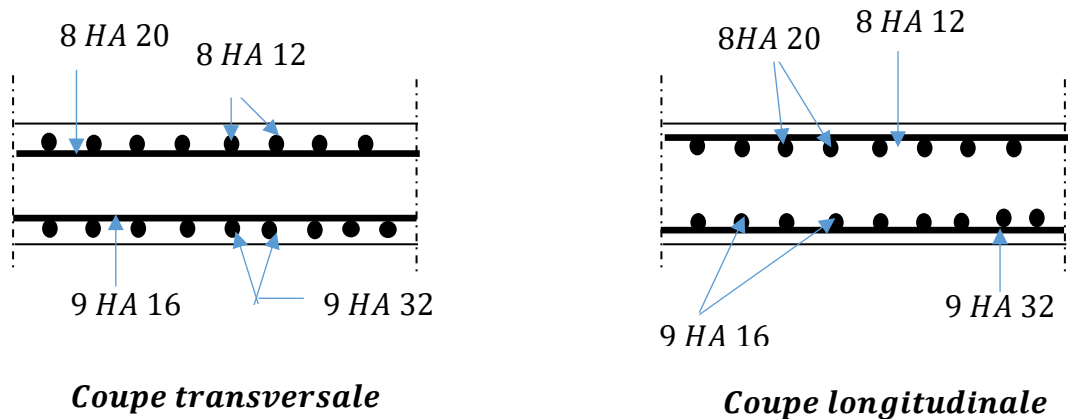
Schéma de ferrailage de la dalle de transition.
